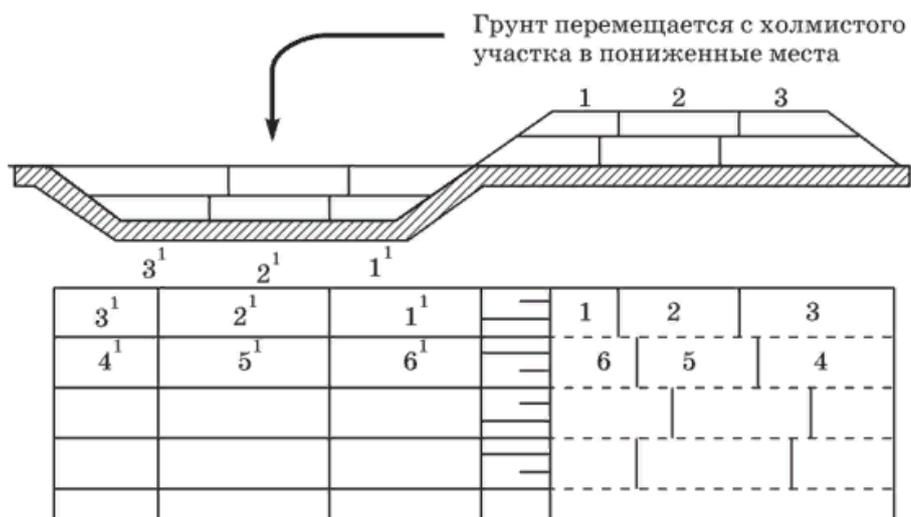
Схема разработки выемки при продольном перемещении грунта с отметками ниже этой плоскости (ямы, овраги, насыпь земляного полотна)
